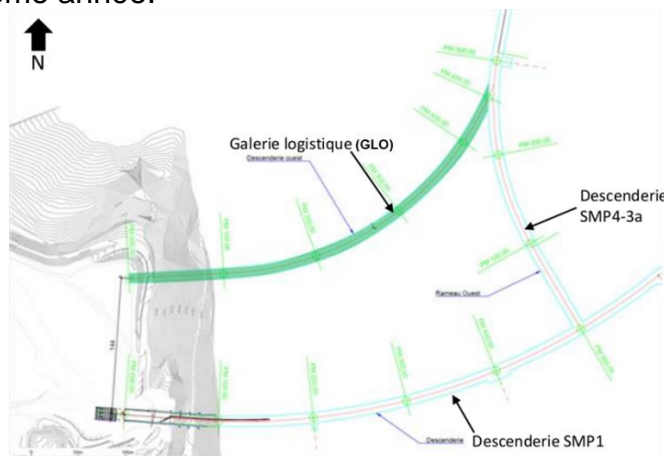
Plan de situation de la nouvelle galerie logistique (GLO) sur le site de Saint-Martin-La-Porte
